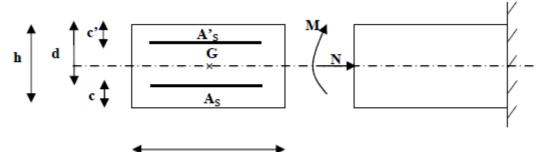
Section de l'acrotère soumise à la flexion composée
